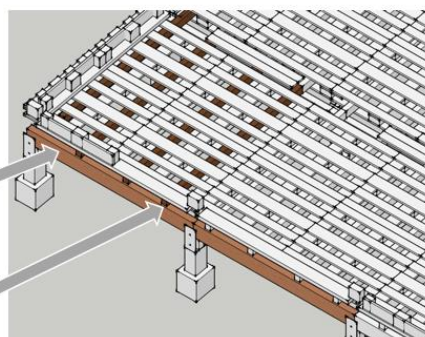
Cargas Vigas de entrepiso proyecto.
